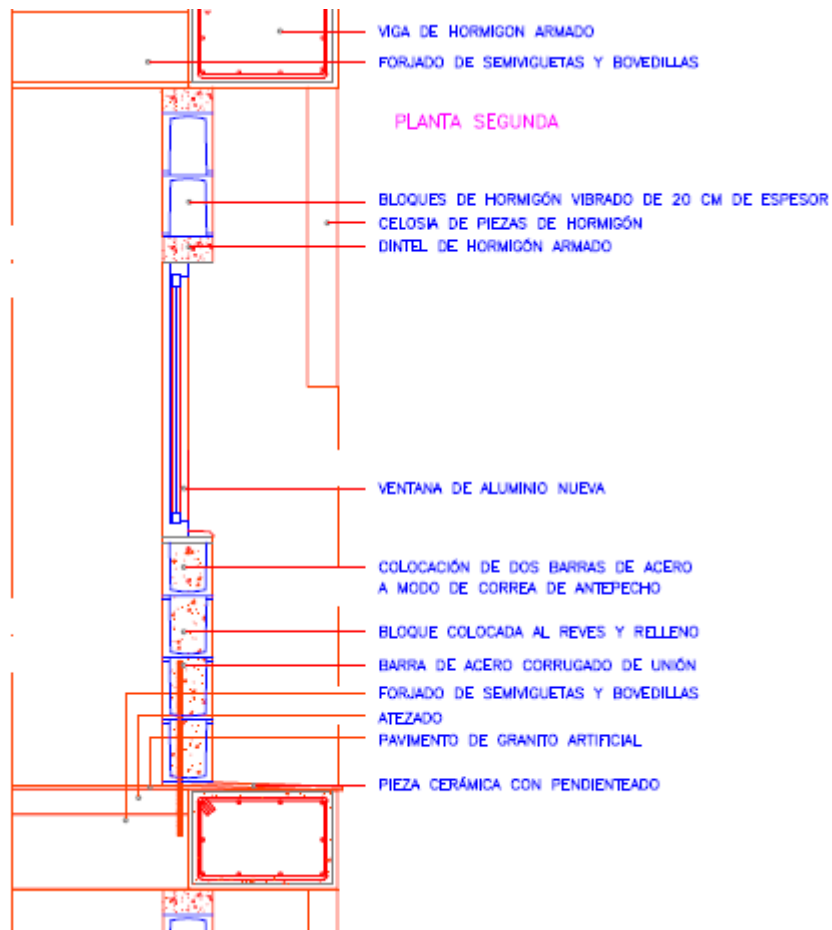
Detalle de parapeto de bloques de hormigón.
